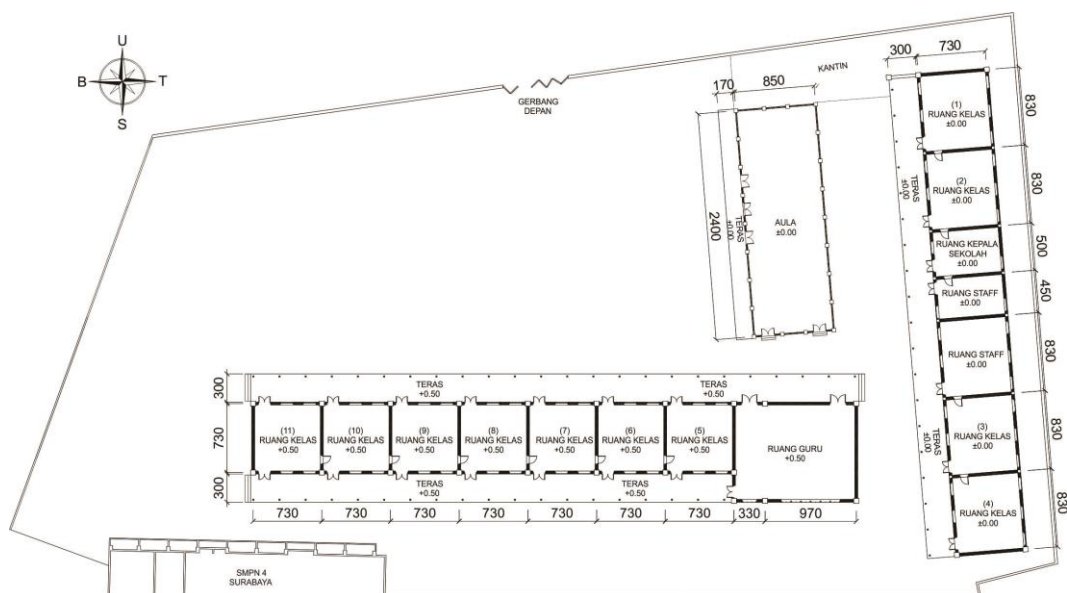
Denah Massa A SMPN 3 Surabaya
